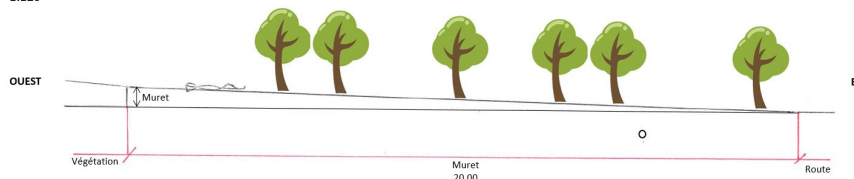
Plan du profil du jardin pluvial de la zone SUD, au niveau de la coupe 3.
